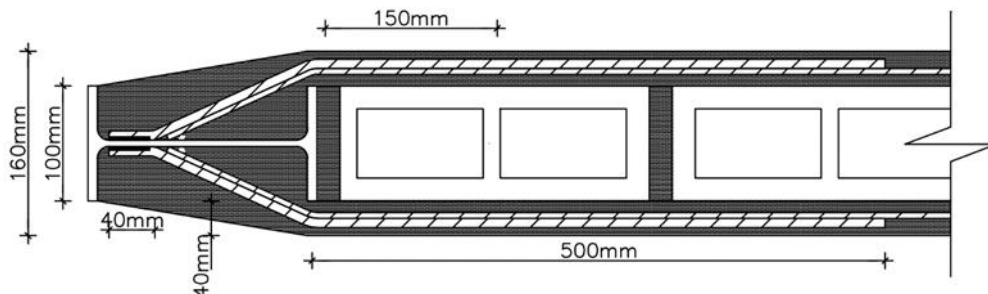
Esquema en planta de conexión entre columnas y enchape del prototipo II
